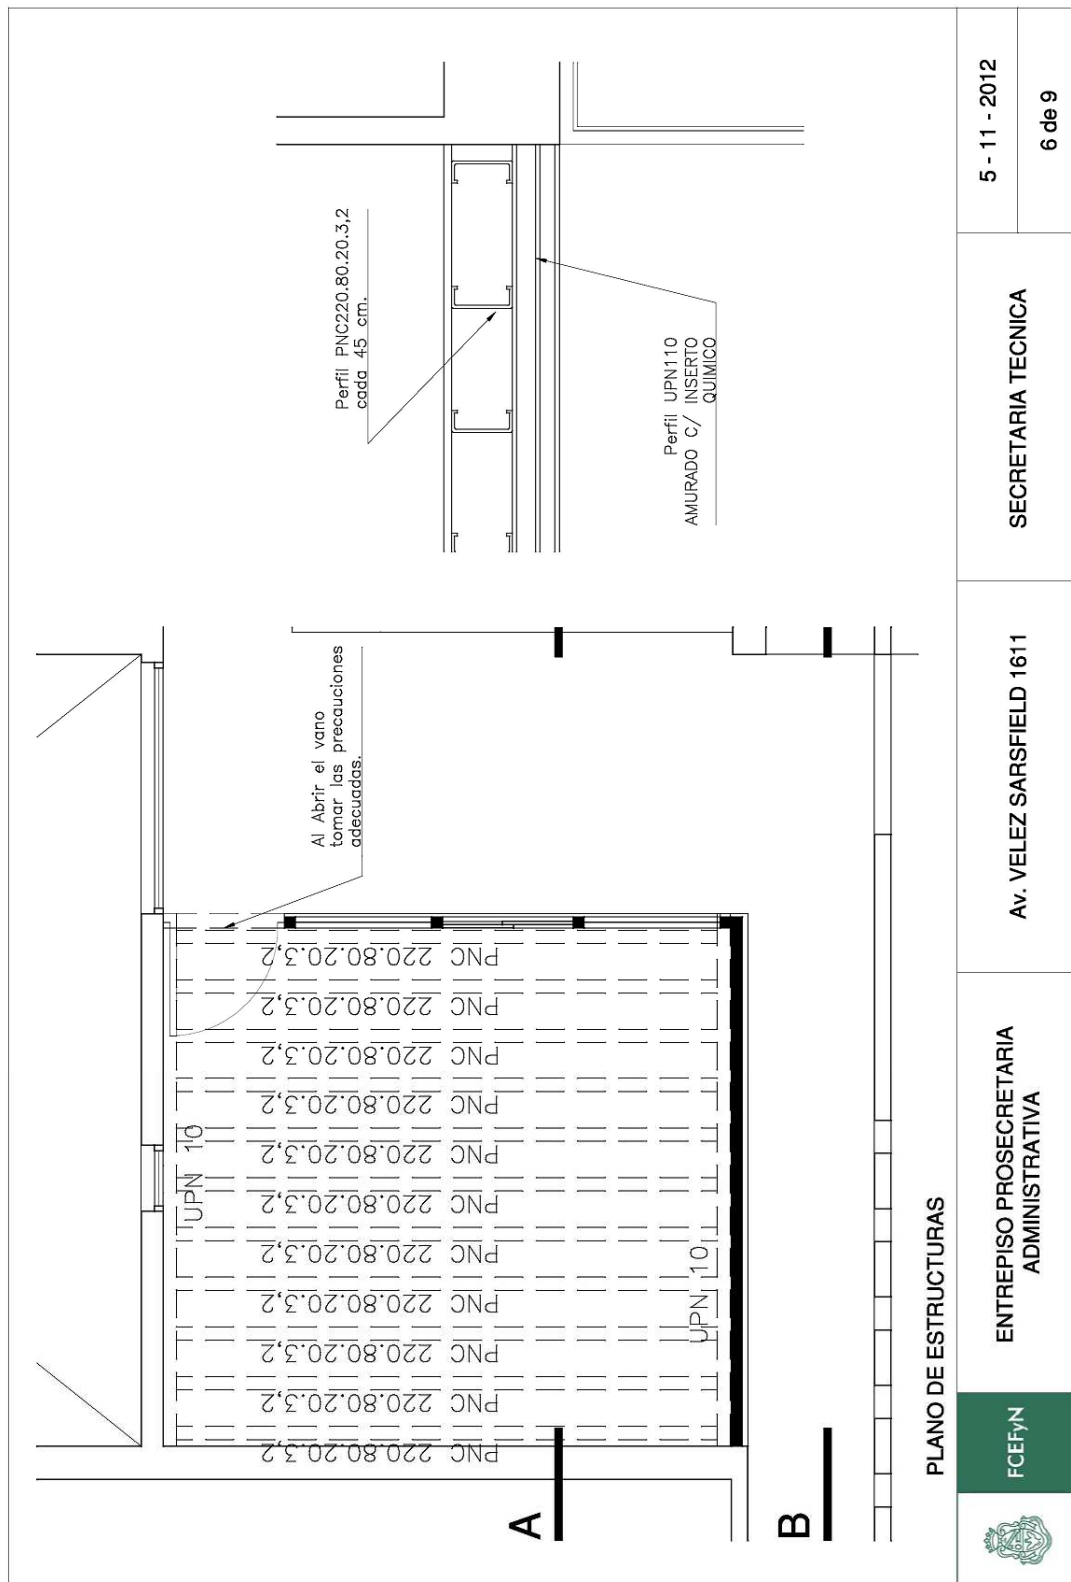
Plano 6 – Fuente: Digitalización de planos originales
